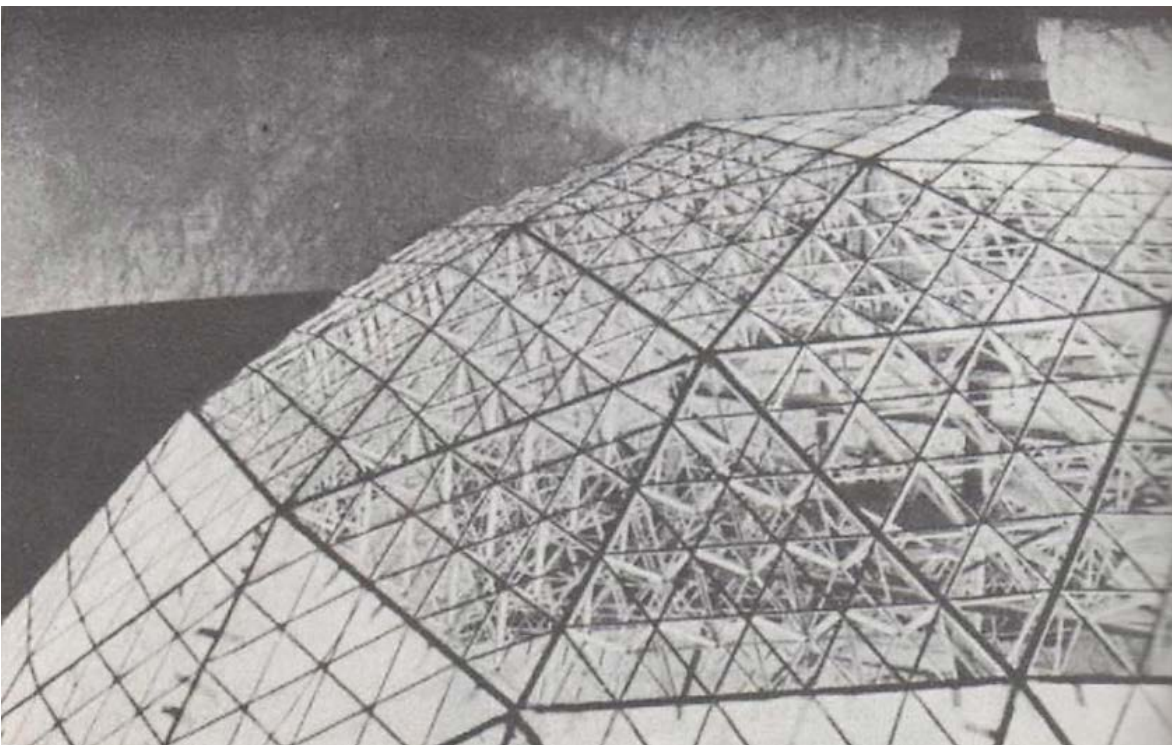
Estructura espacial formada por el sistema “octet truss”. Donde las cargas se distribuyen uniformemente en el conjunto.
